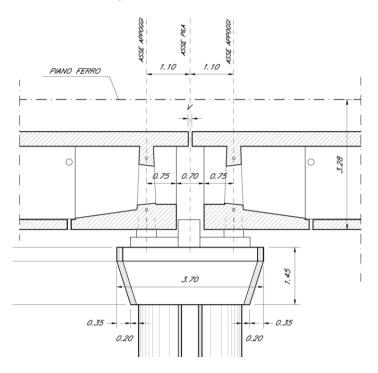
Pila, prospetto longitudinale - Due impalcati CAP
